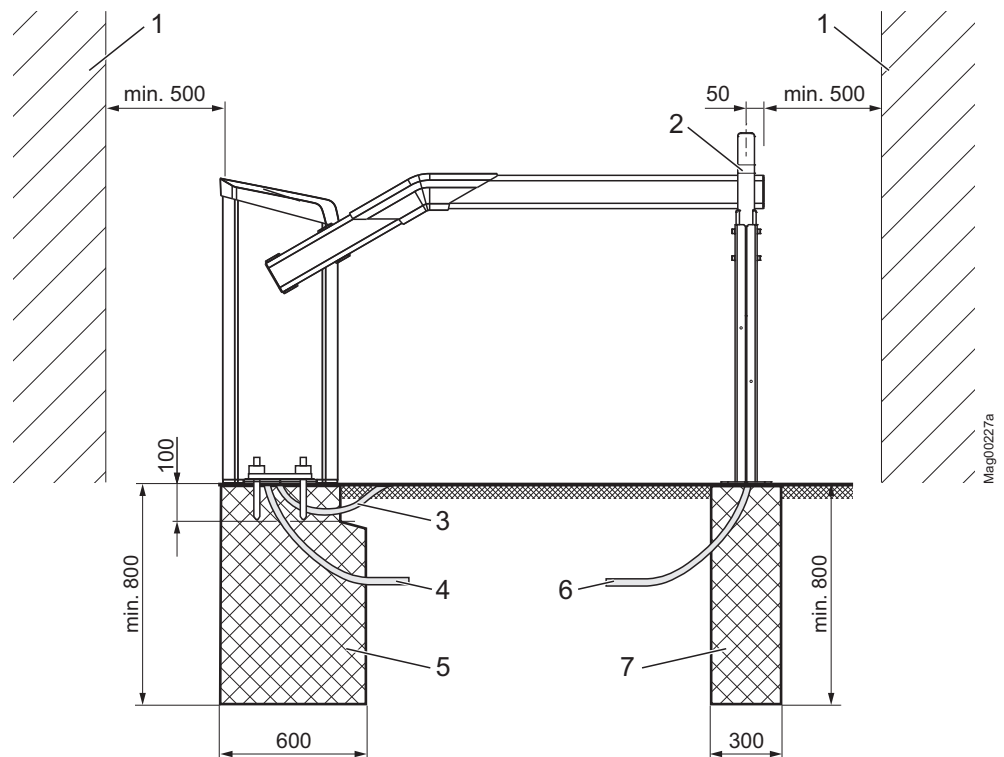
Montering bomsystem, här beskrivet för bomtyp "Access/Parking" (mått i mm)
